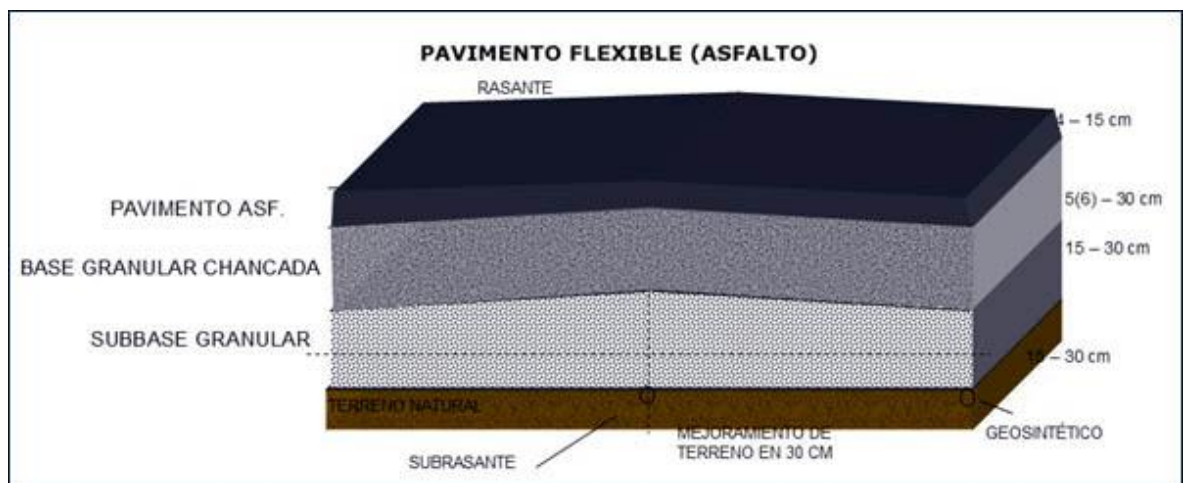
Corte transversal típica de la estructura de un pavimento flexible.
